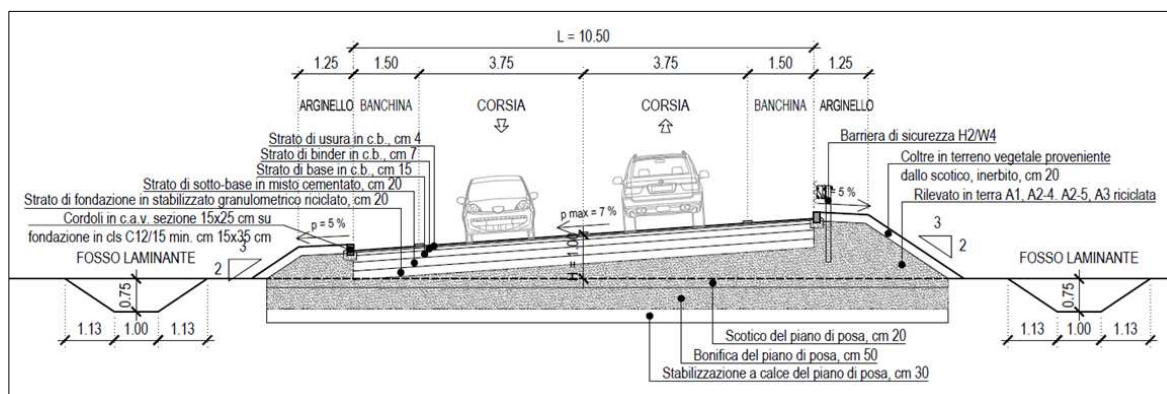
sezione stradale C1 per l'asse principale della variante.
